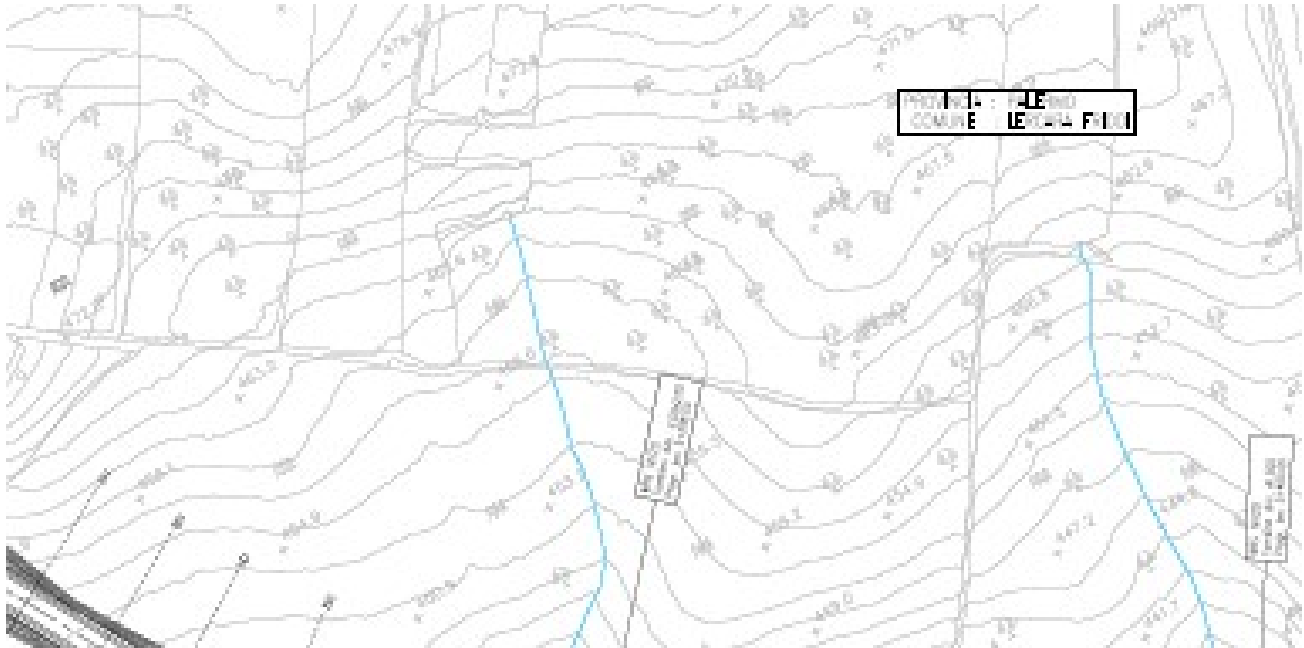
Planimetria di progetto dalla Km 5+145 a fine intervento NV20
